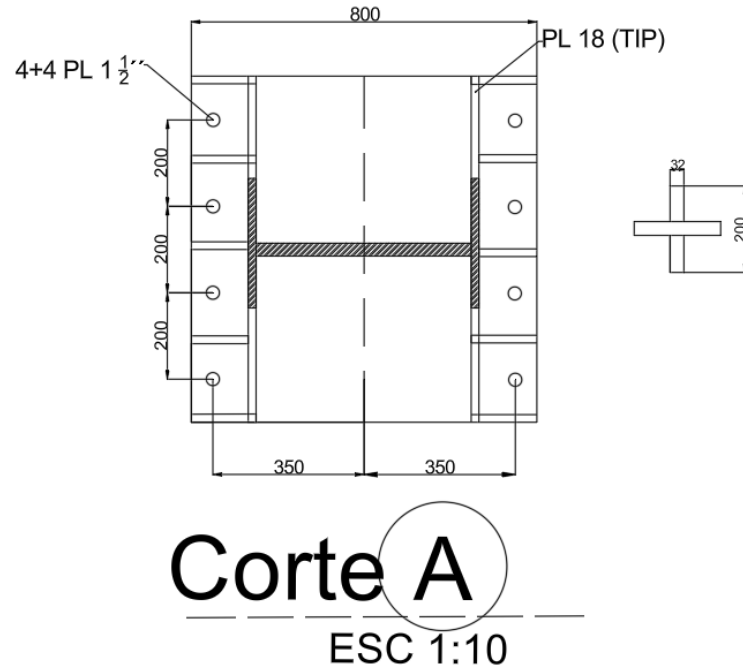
Detalle placa base 1 con silla de anclaje, atiesadores y llave de corte
